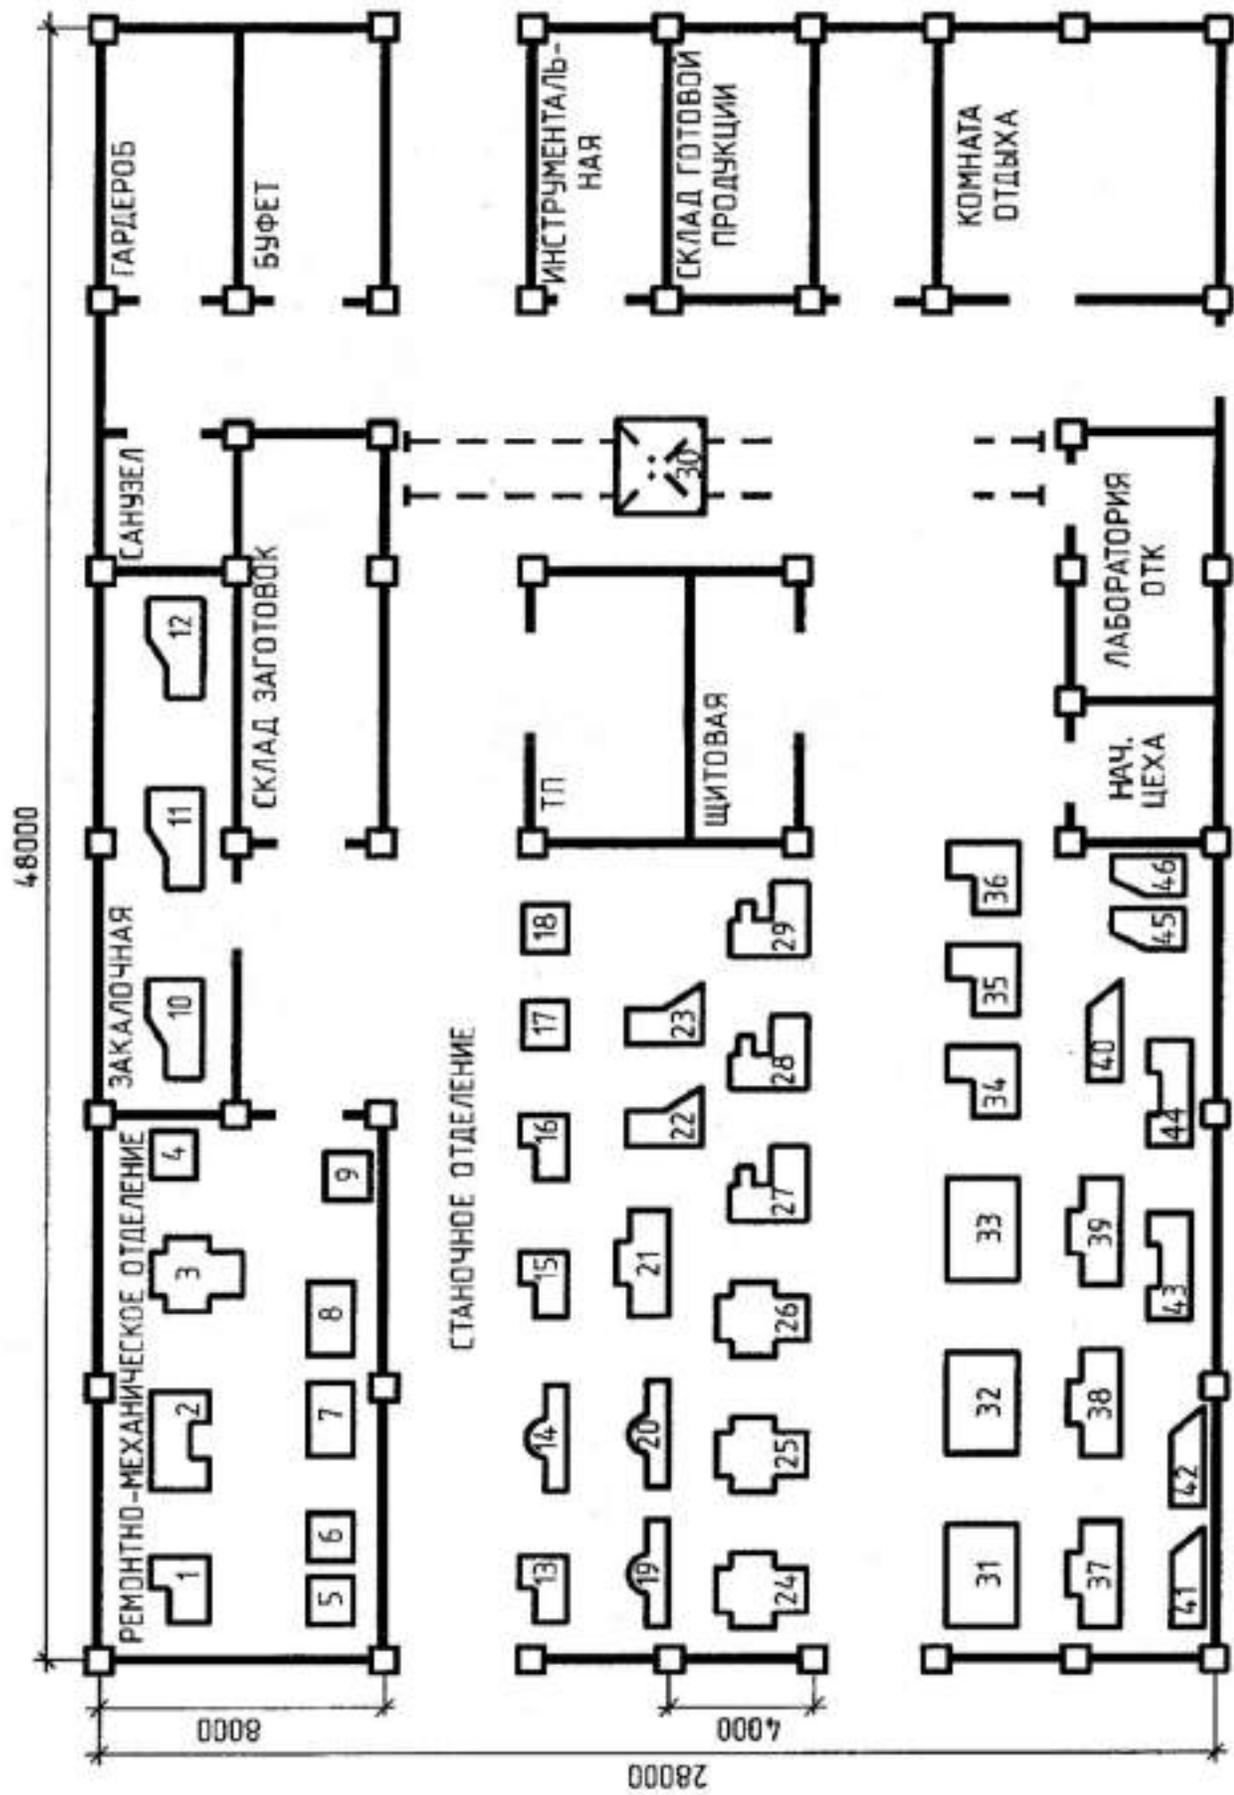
План расположения ЭО цеха механической обработки деталей
